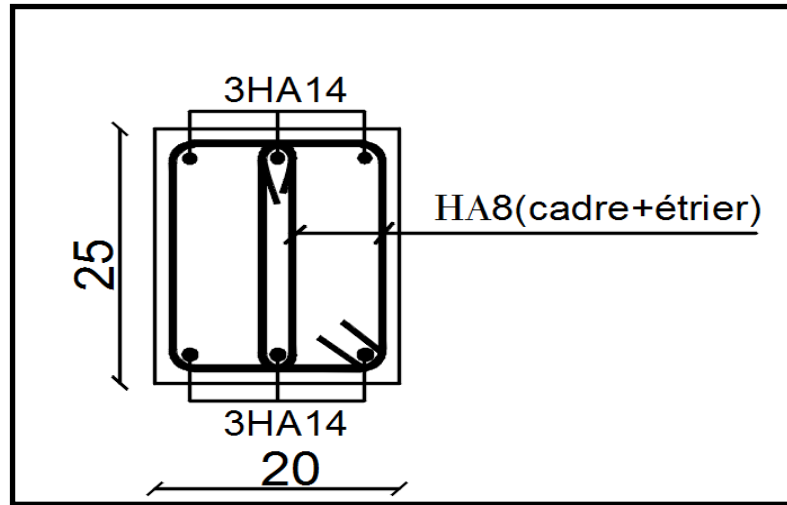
Ferraillage aux appuis d'une poutre secondaire.
